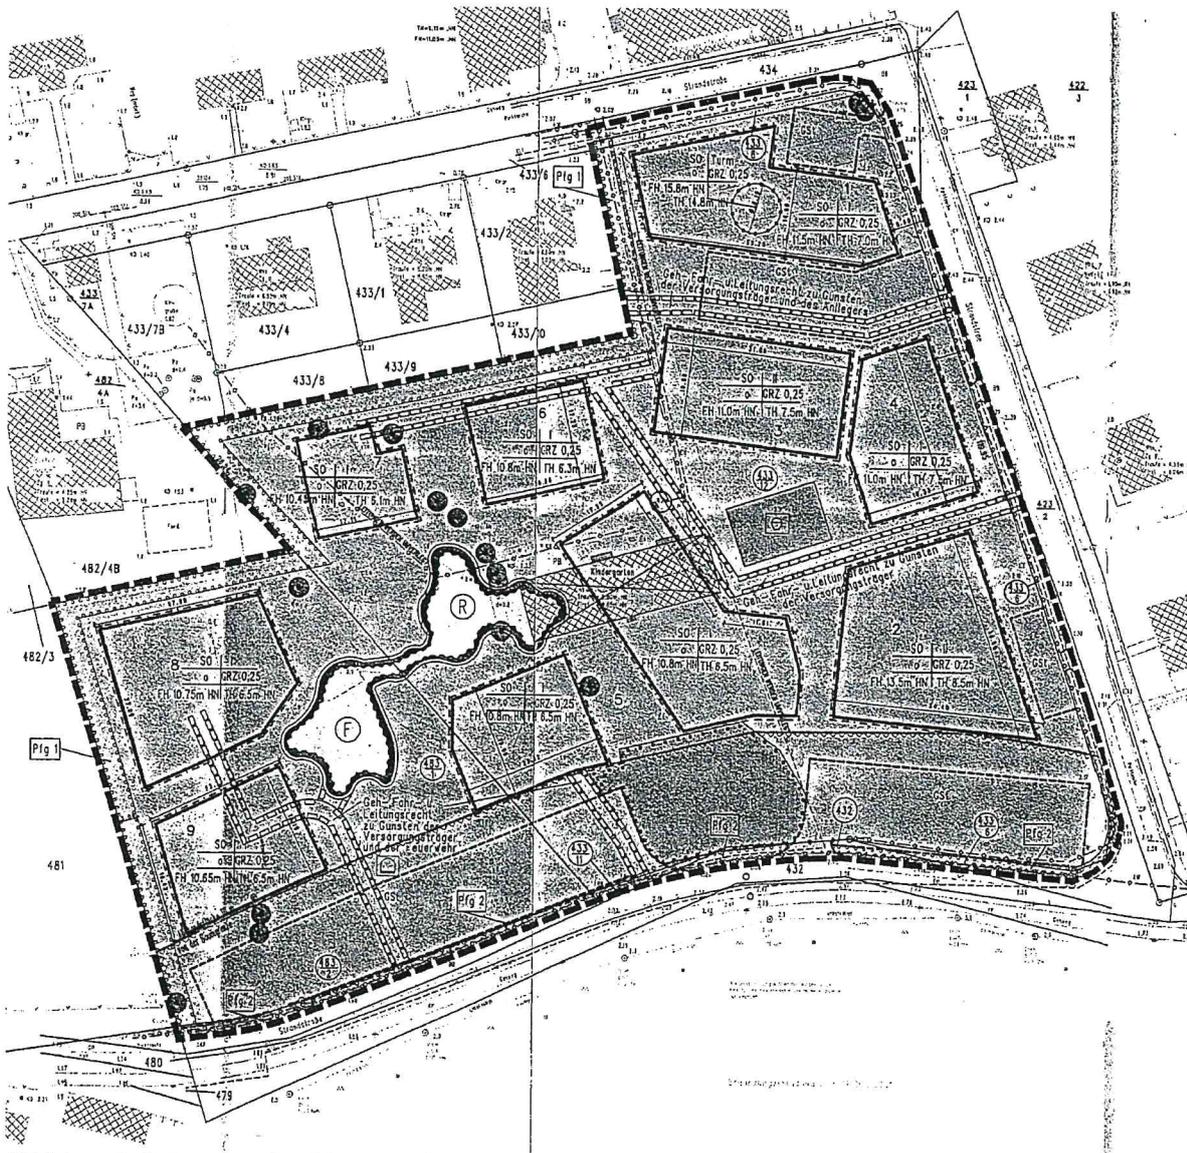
Bebauungsplan (Ursprungsfassung)
